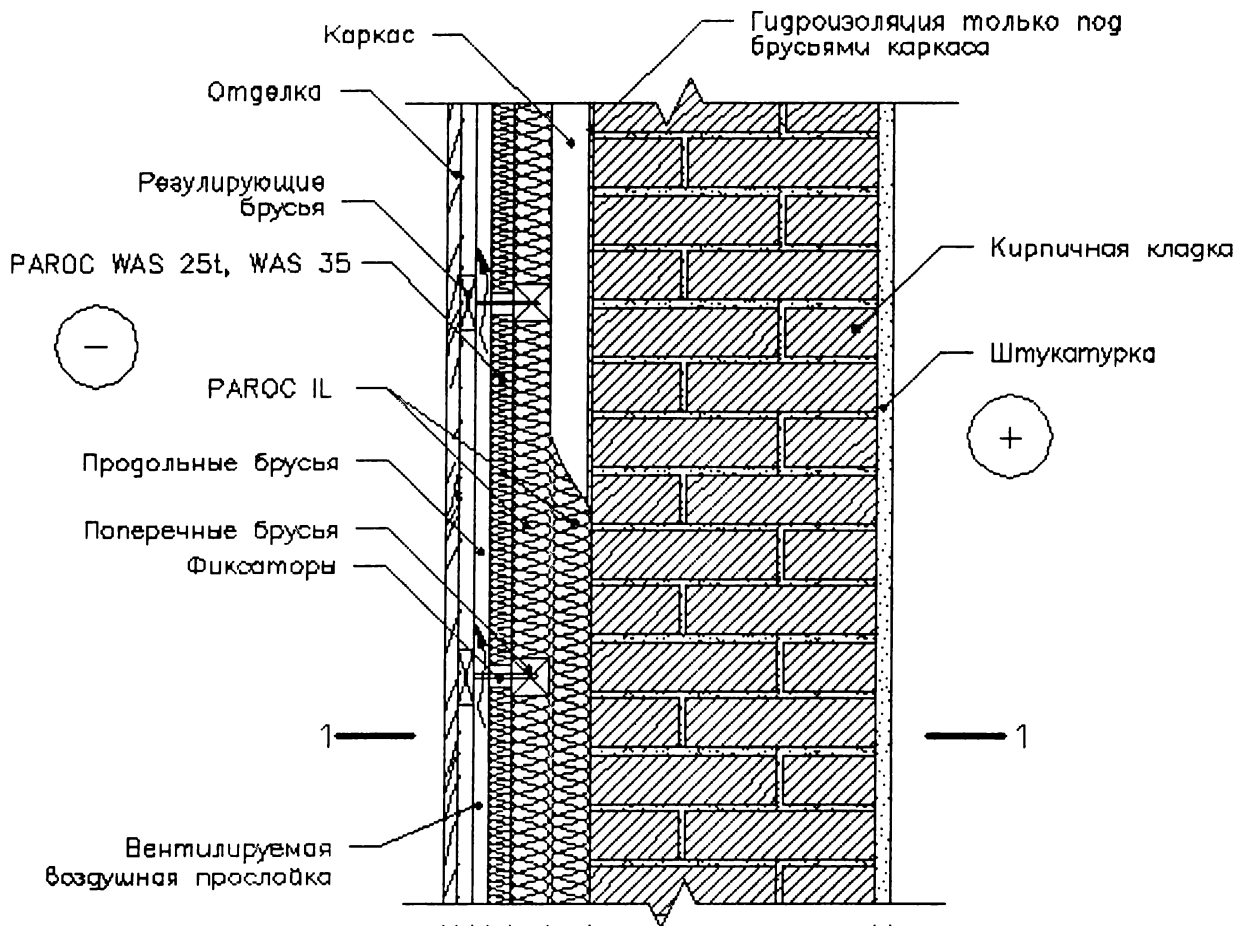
Стена кирпичная, утепленная снаружи, с применением деревянного каркаса и ветроизоляционной плиты WAS 25t или WAS 35
